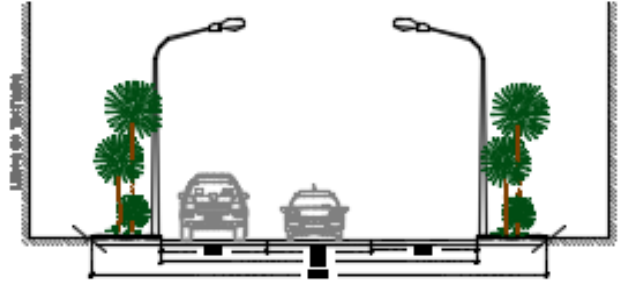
Propuesta Perfil Calle 3, 4 y carretera 5 (2018)
